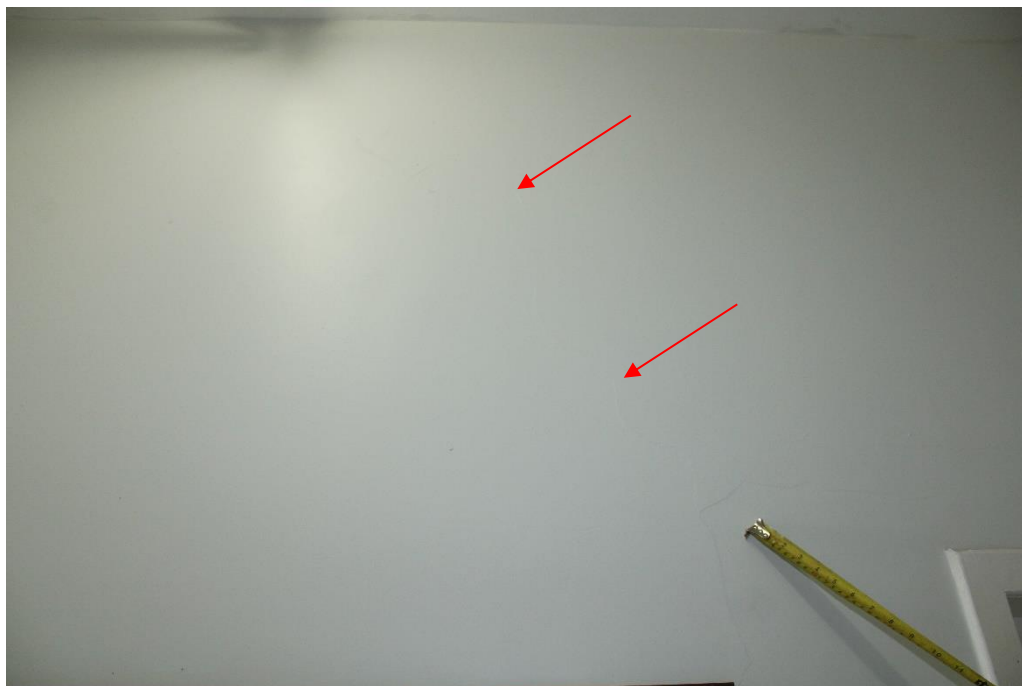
Em detalhe a Foto acima, destacando sinais de correção de fissuras.
